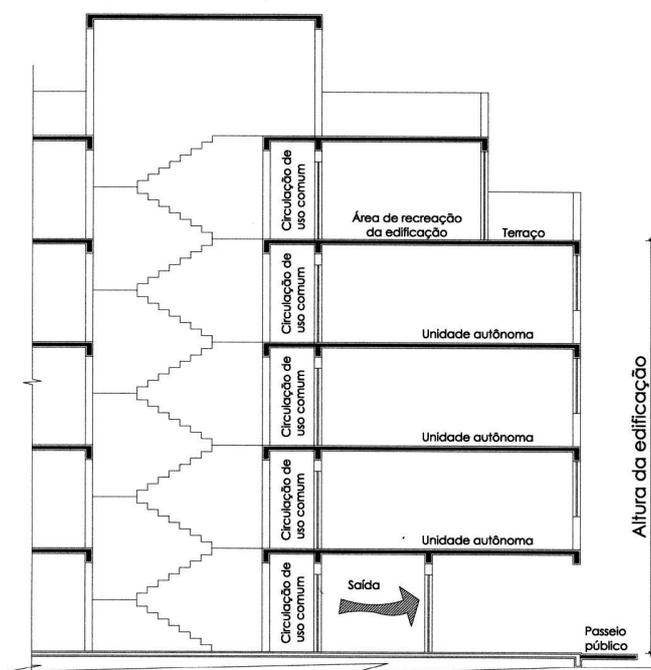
Último pavimento constituído por construção em terraço, destinada a salão de recreação como dependência de uso comum da edificação.
